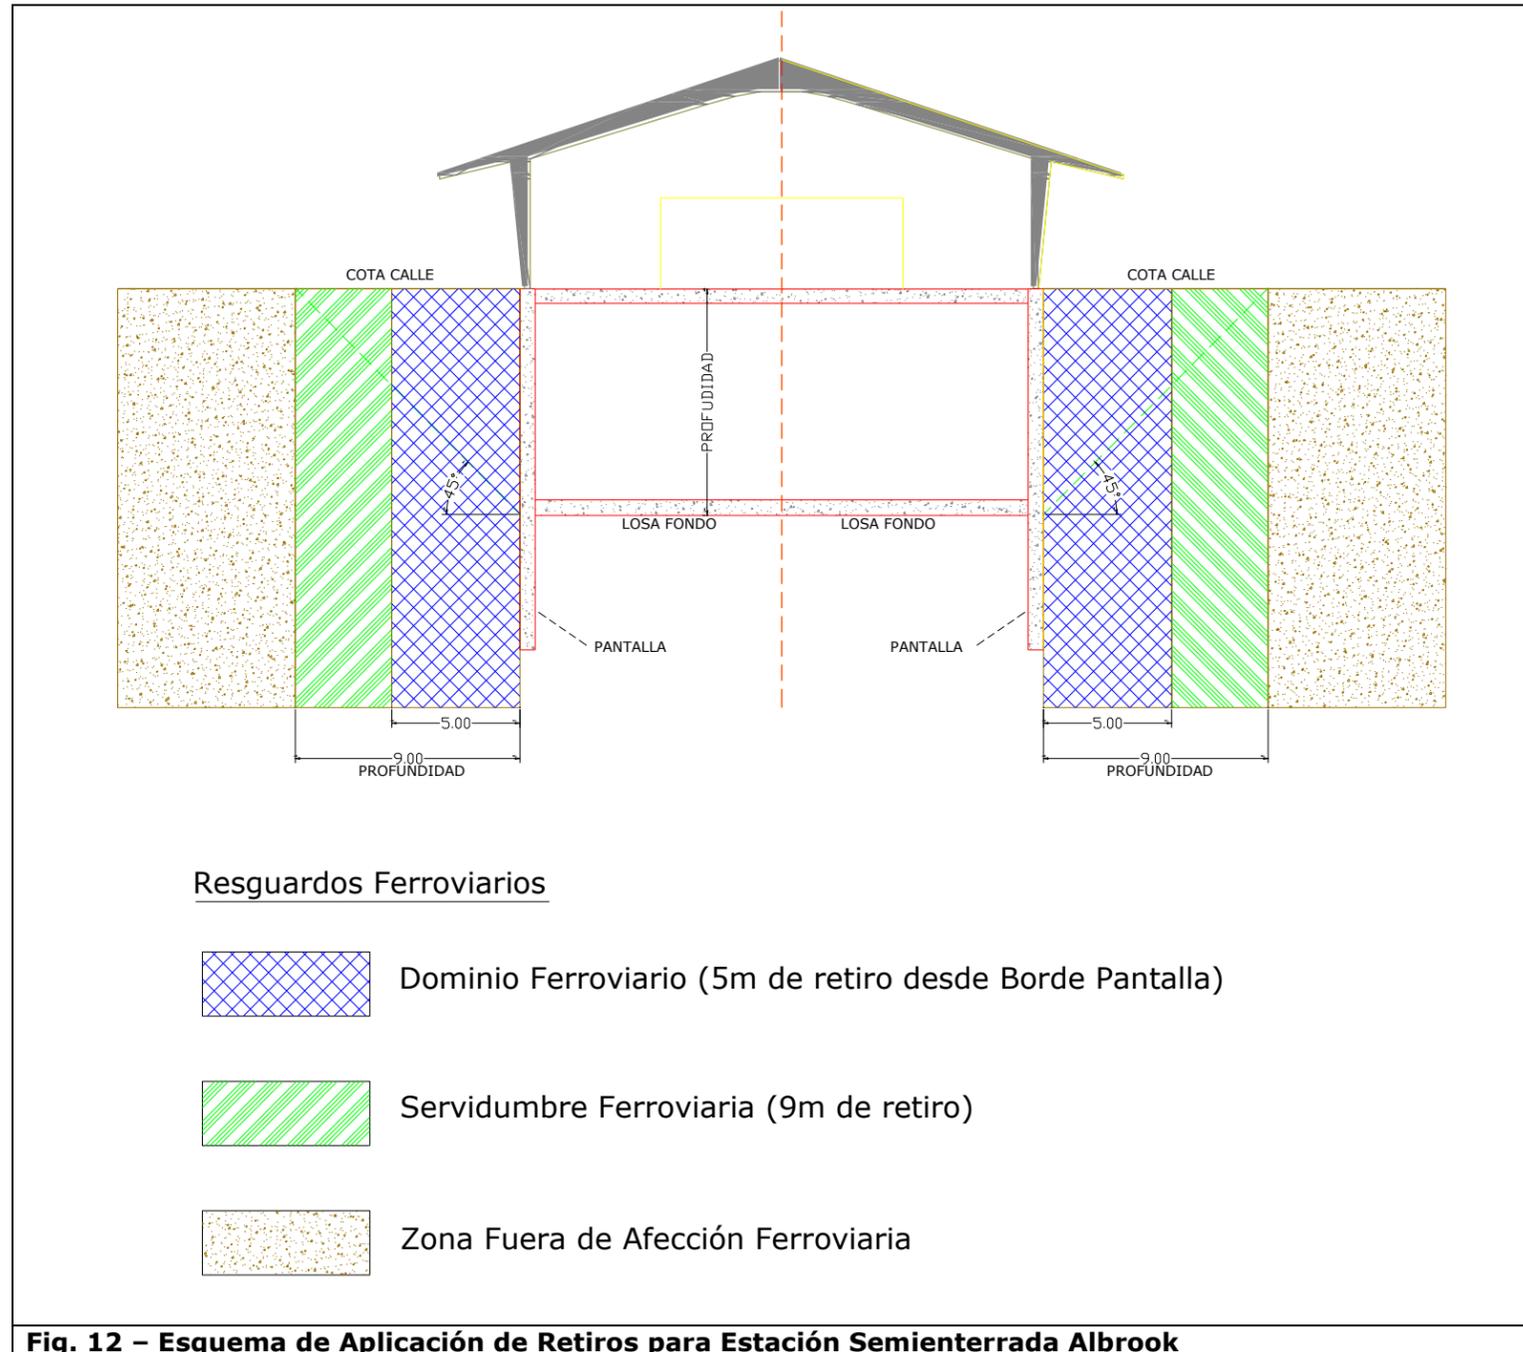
Esquema de Aplicación de Retiros para Estación Semienterrada Albrook
